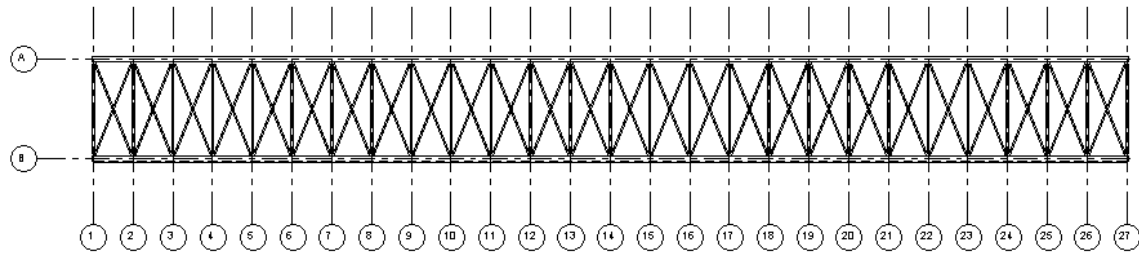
Vista superior de las vigas longitudinales, viguetas transversales y tornapuntas
